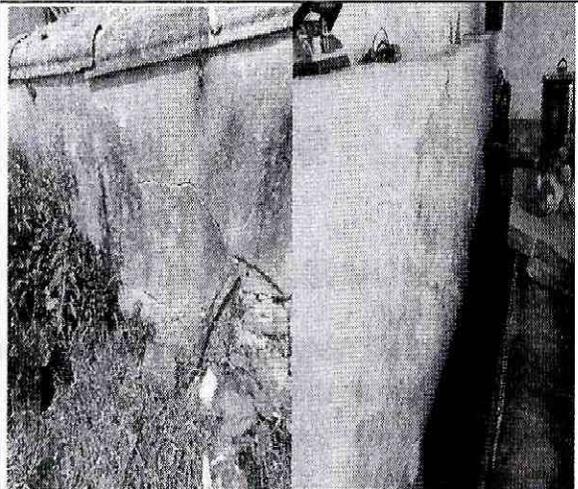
Muro deteriorado con fisuras de 5 a 7 mm habitación posterior vivienda de la Carrera 15 Bis E No 57- 16 Sur,
